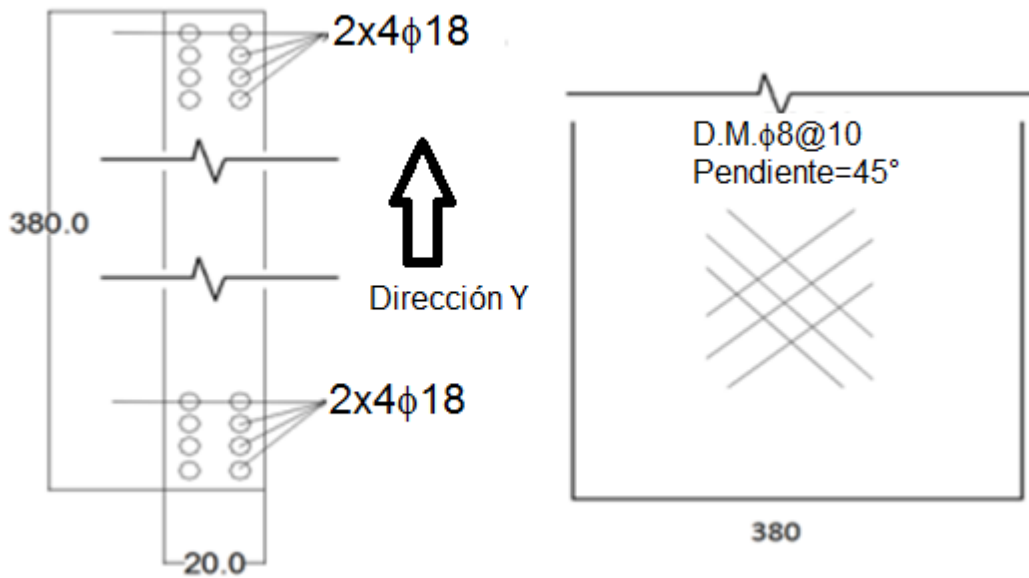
Detalle de armaduras del elemento B4-3, corte transversal y elevación
